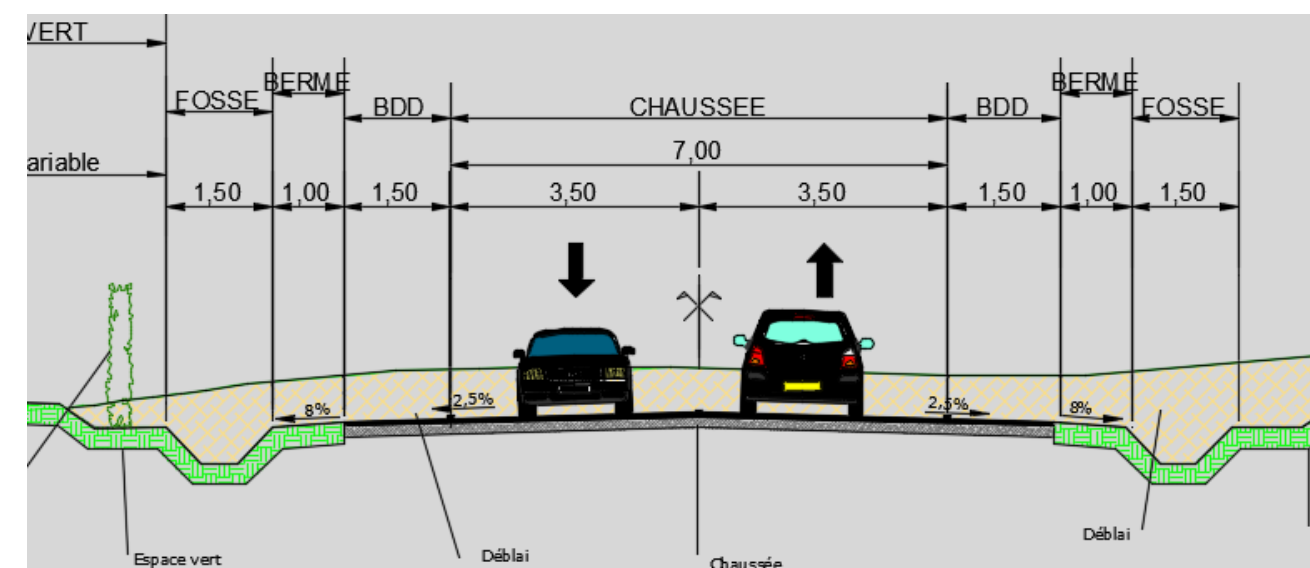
Profil en travers de la RD6 en section à 2 voies
